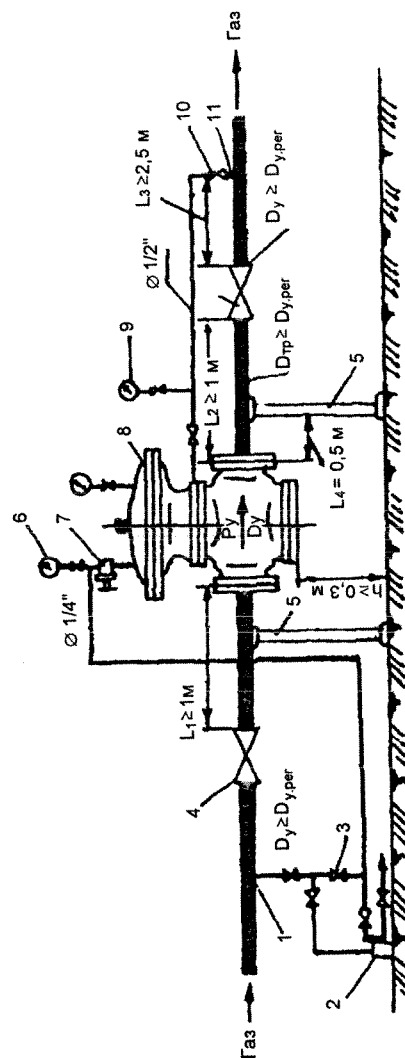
Схема установки и обвязки регулятора типа РД-64:
